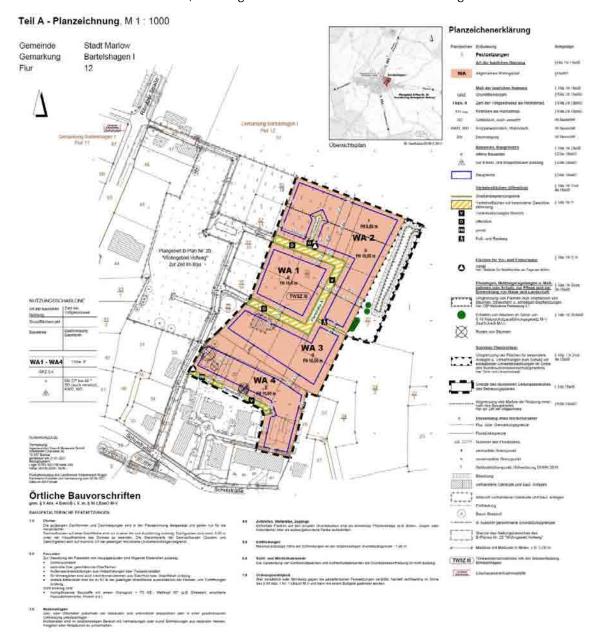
Ausschnitt B-Plan Nr. 26 - Satzung, Darstellung des Plangebietes. Quelle: BAB Wismar 2021.
